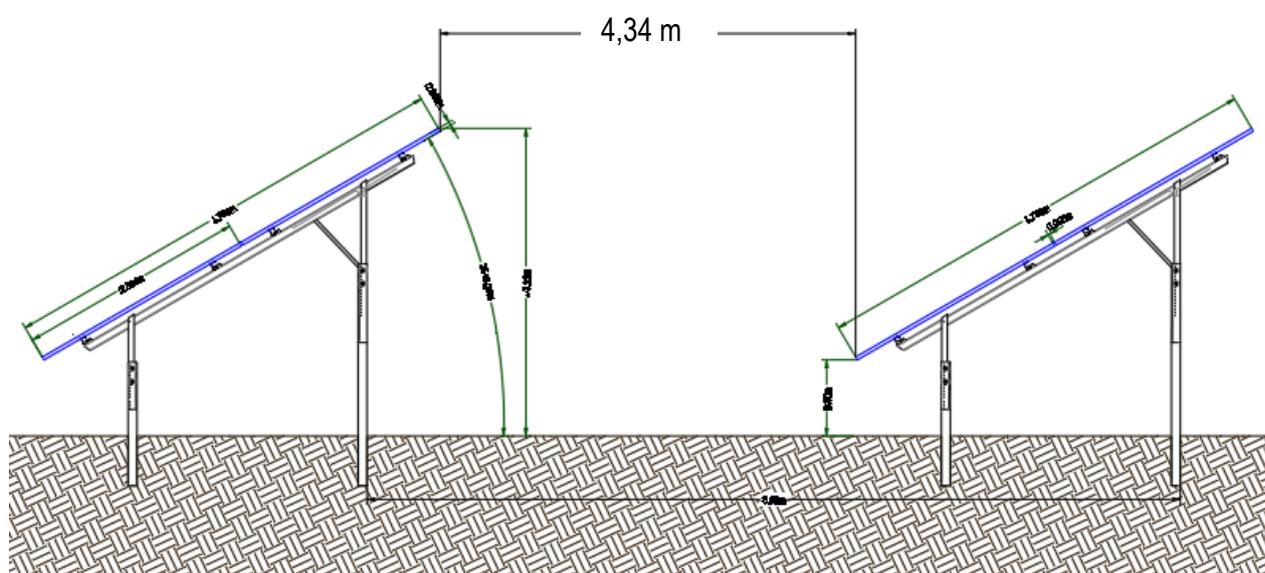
Sezione tipo delle strutture trackers previste dal progetto
